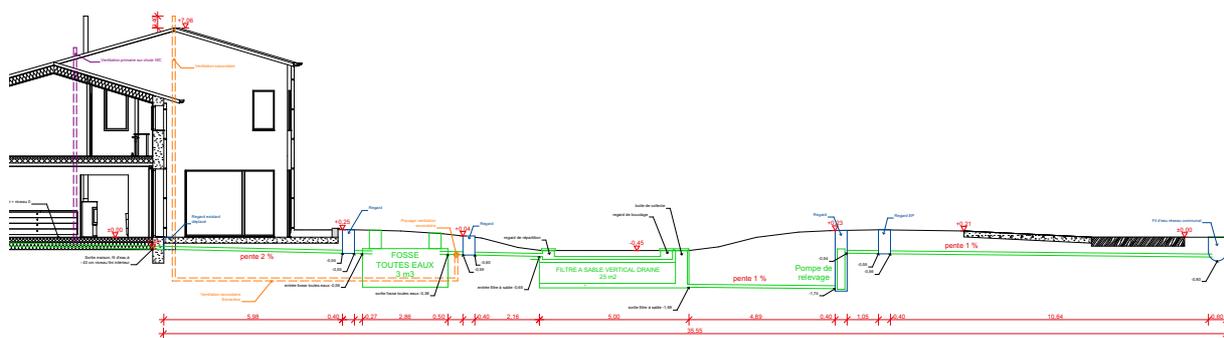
Coupe en long filière assainissement - © Atelier MPA
